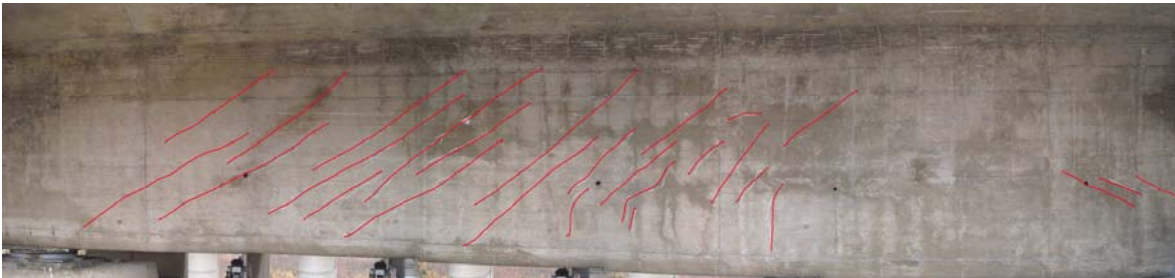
Fisuras oblicuas por cortante en tablero
